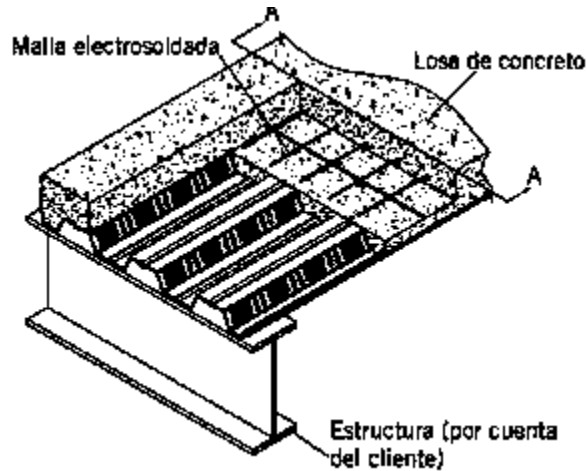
Detalle arquitectónico de lozacero vigas y armado de concreto. <http://www.cubiertastexas.com>
